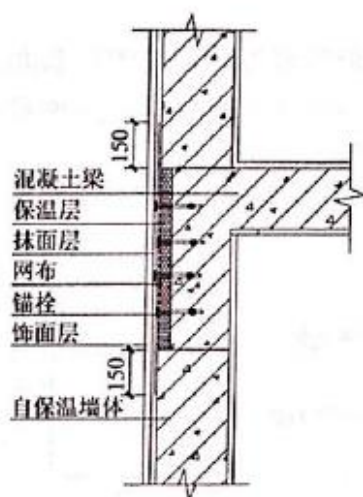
混凝土梁与自保温墙体连接平面构造
